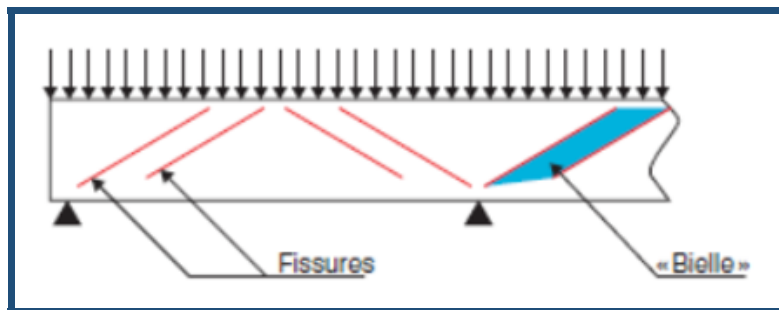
Fissuration d'une poutre sur 2 appuis simple
